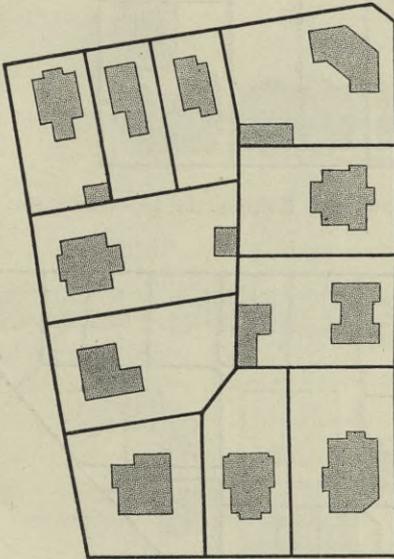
Offene Bauweise mit großen Abständen und kleinen Nebengebäuden.
